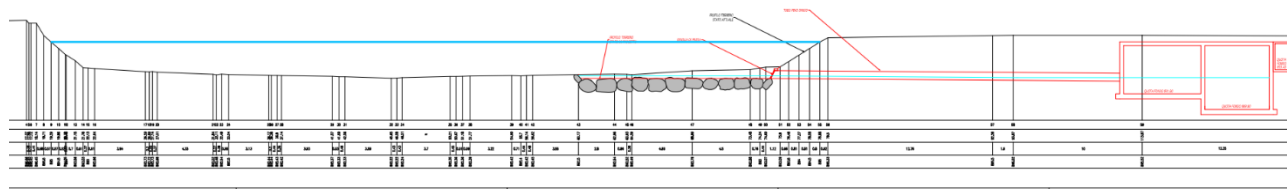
Pianta delle opere di derivazione dal torrente Avisio.
